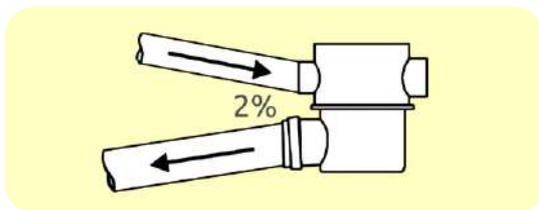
Detalhes técnicos da caixa sifonada girafácil com inclinação de 2%
